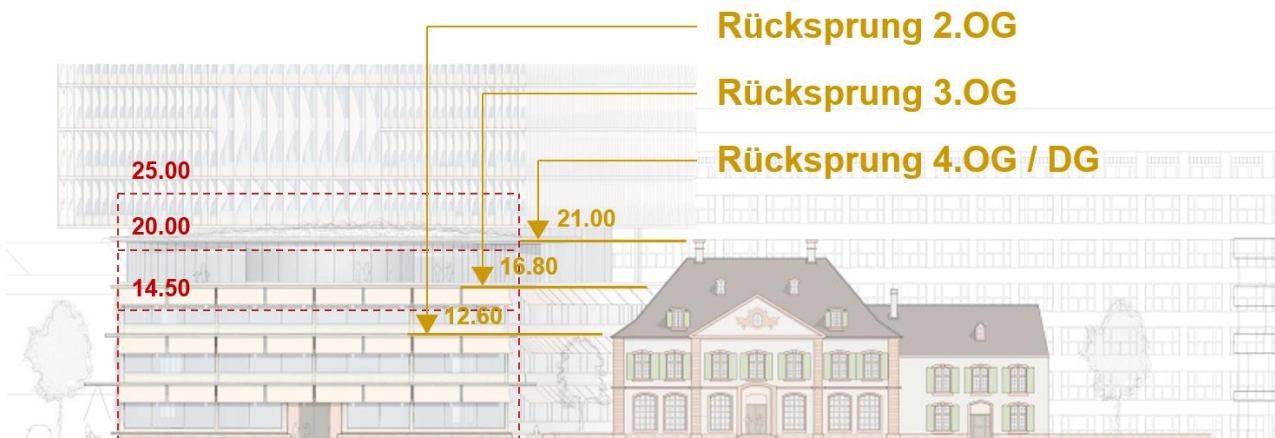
Südfassade WB-Projekt Herzog & de Meuron / Rapp (April 2019) mit Massangaben Projekt (ocker) und Bebauungsplan (rot)
